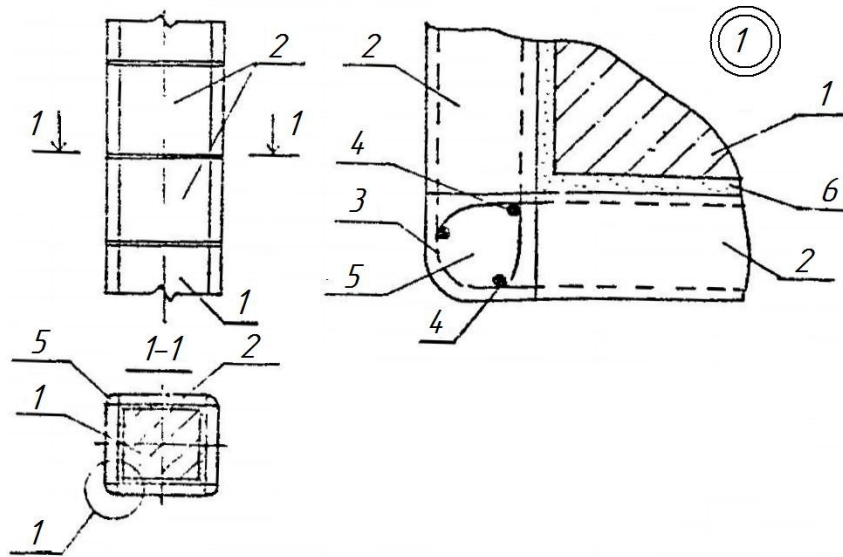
Посилення колон зі сполукою плит обойм на петльових випусках: 1 – посилювана колона; 2 – збірні залізобетонні плити обойми; 3 – петльові випуски арматури із плит; 4 – вертикальні арматурні стрижні; 5 – обетонювання стику; 6 – цементно-піщаний розчин
